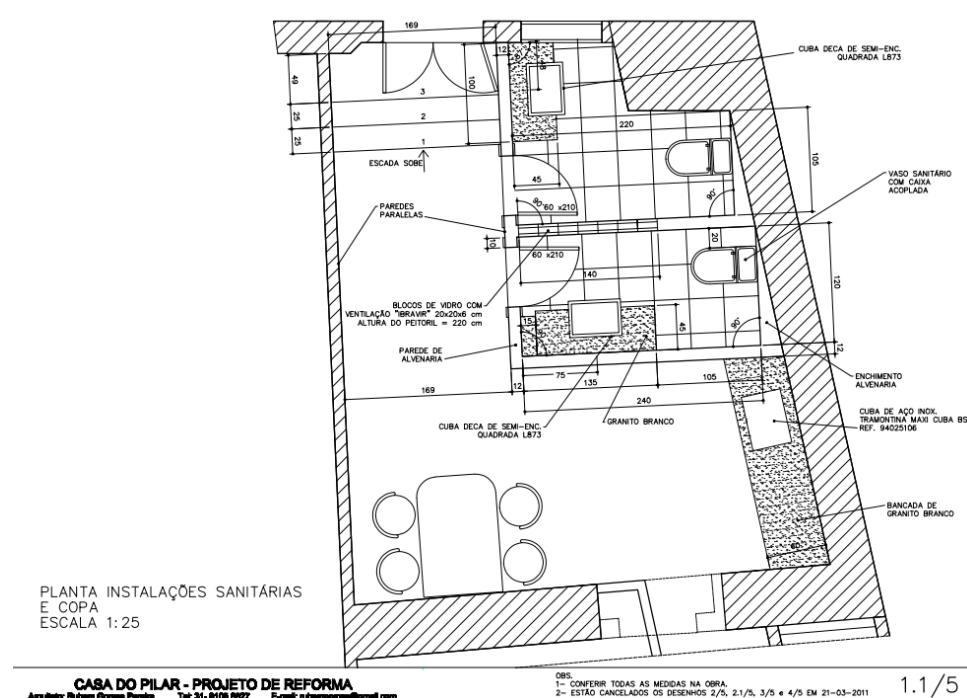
Planta Casa do Pilar – Detalhe Banheiro 02 – Segundo Piso
